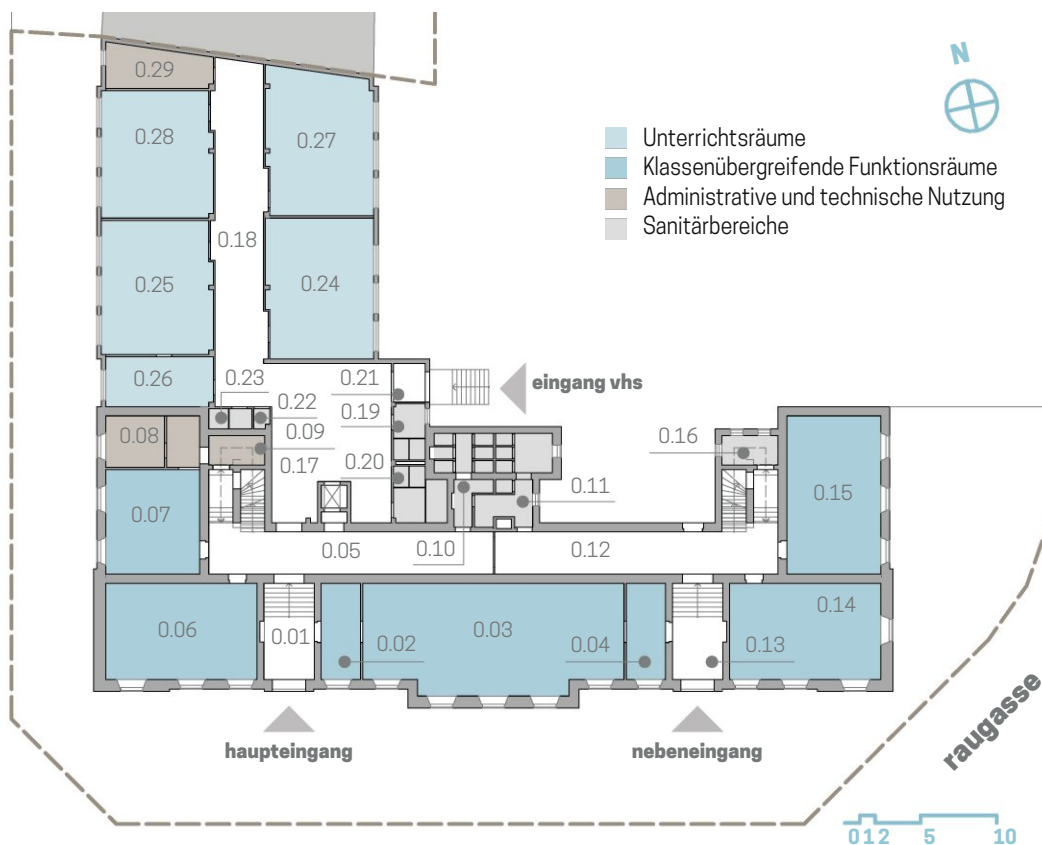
Bestandsaufnahme: Grundriss Erdgeschoß.
